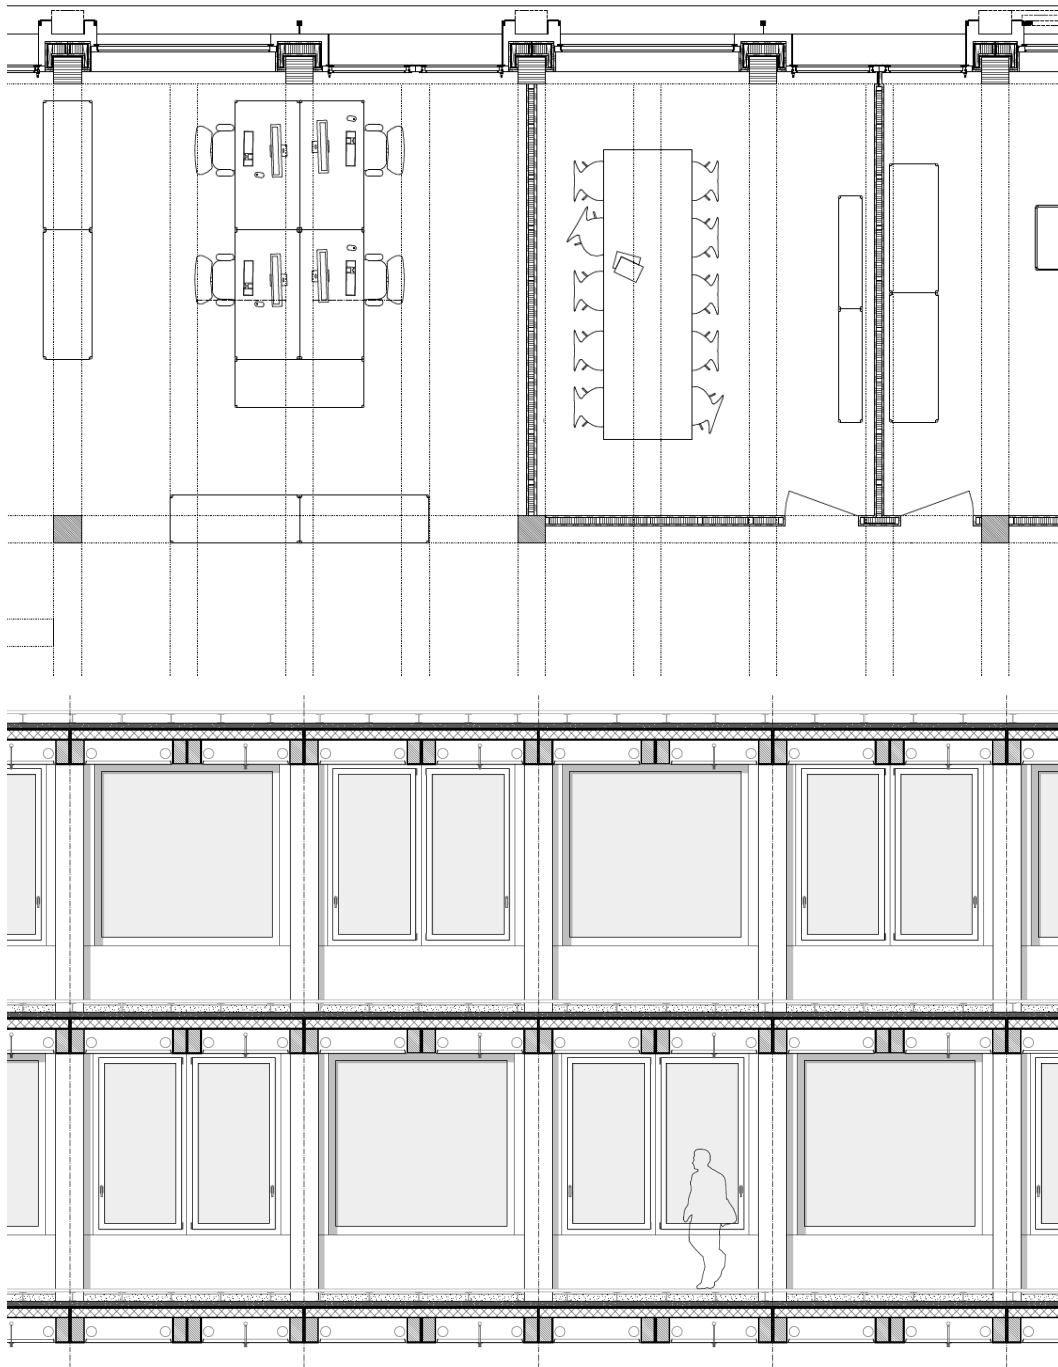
Detailplan Grundriss / Innenansicht Fassade (Bildquelle: Burkard Meyer Architekten)
